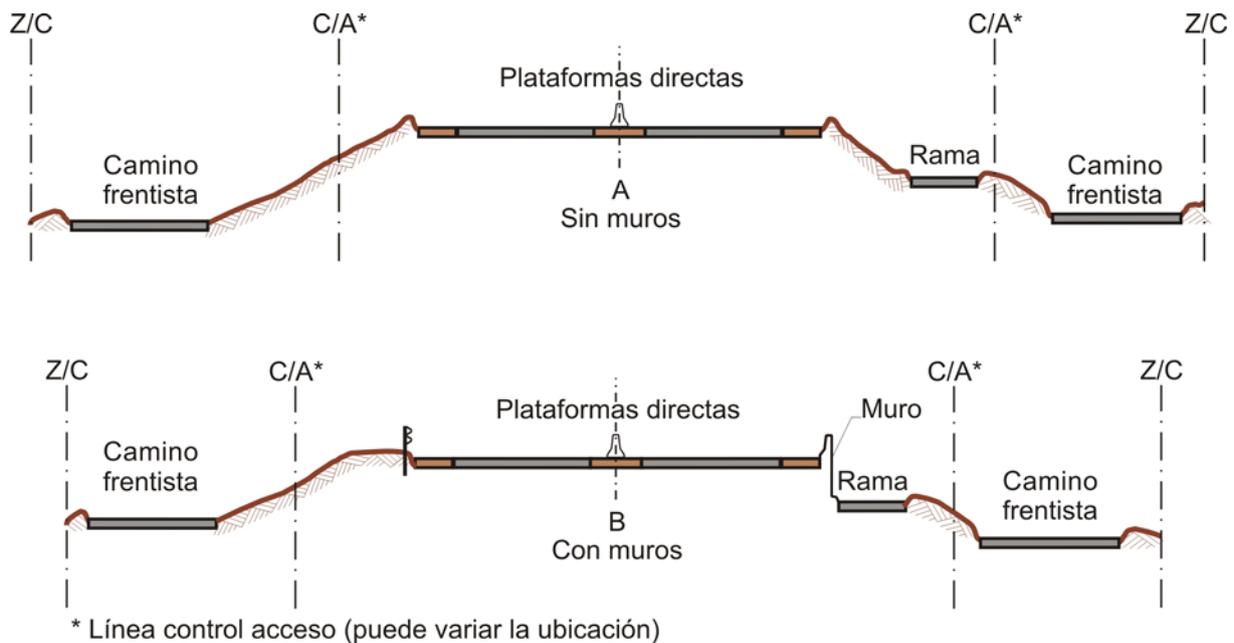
Secciones transversales para autopistas elevadas en terraplén
